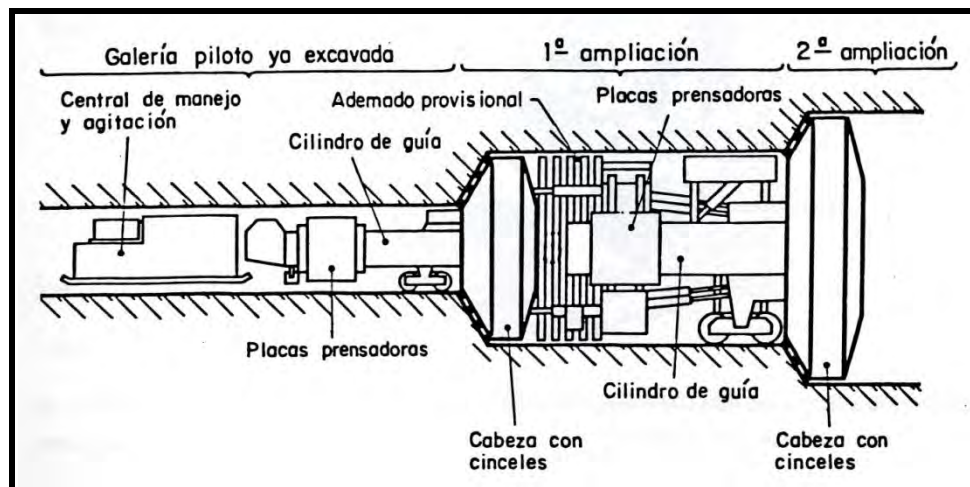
Excavación con túnel piloto y dos máquinas ensanchadoras.
